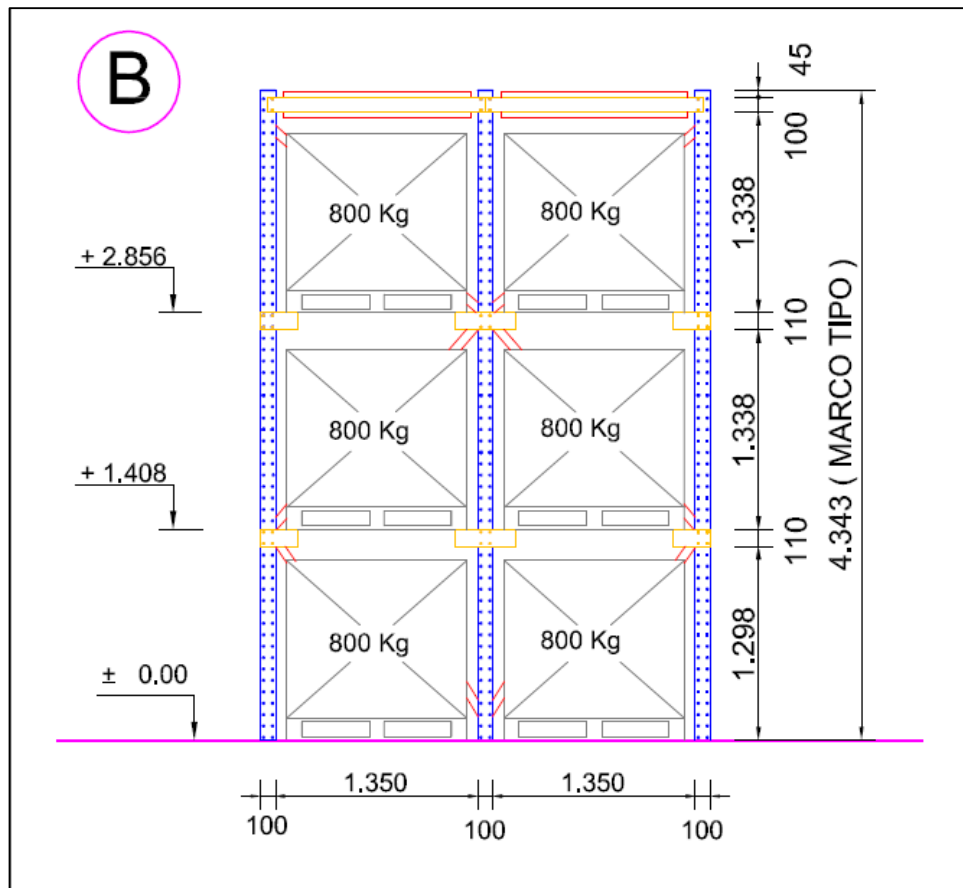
Extracto de elevaciones Estantería Drive in.
